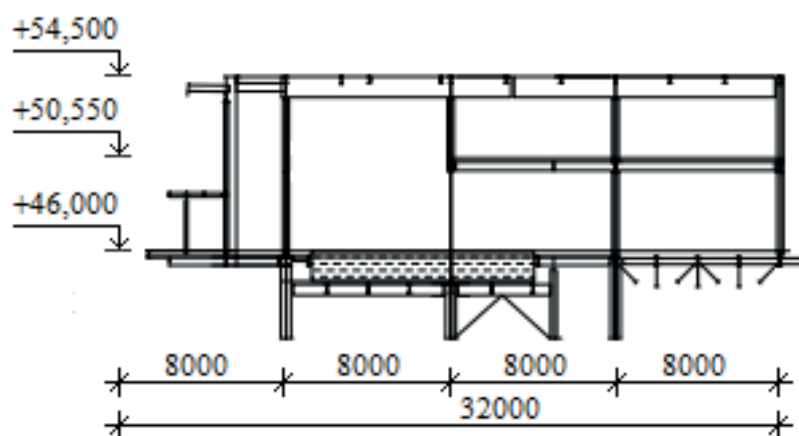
Схема розташування конструктивних елементів перекриття надбудови над басейном
